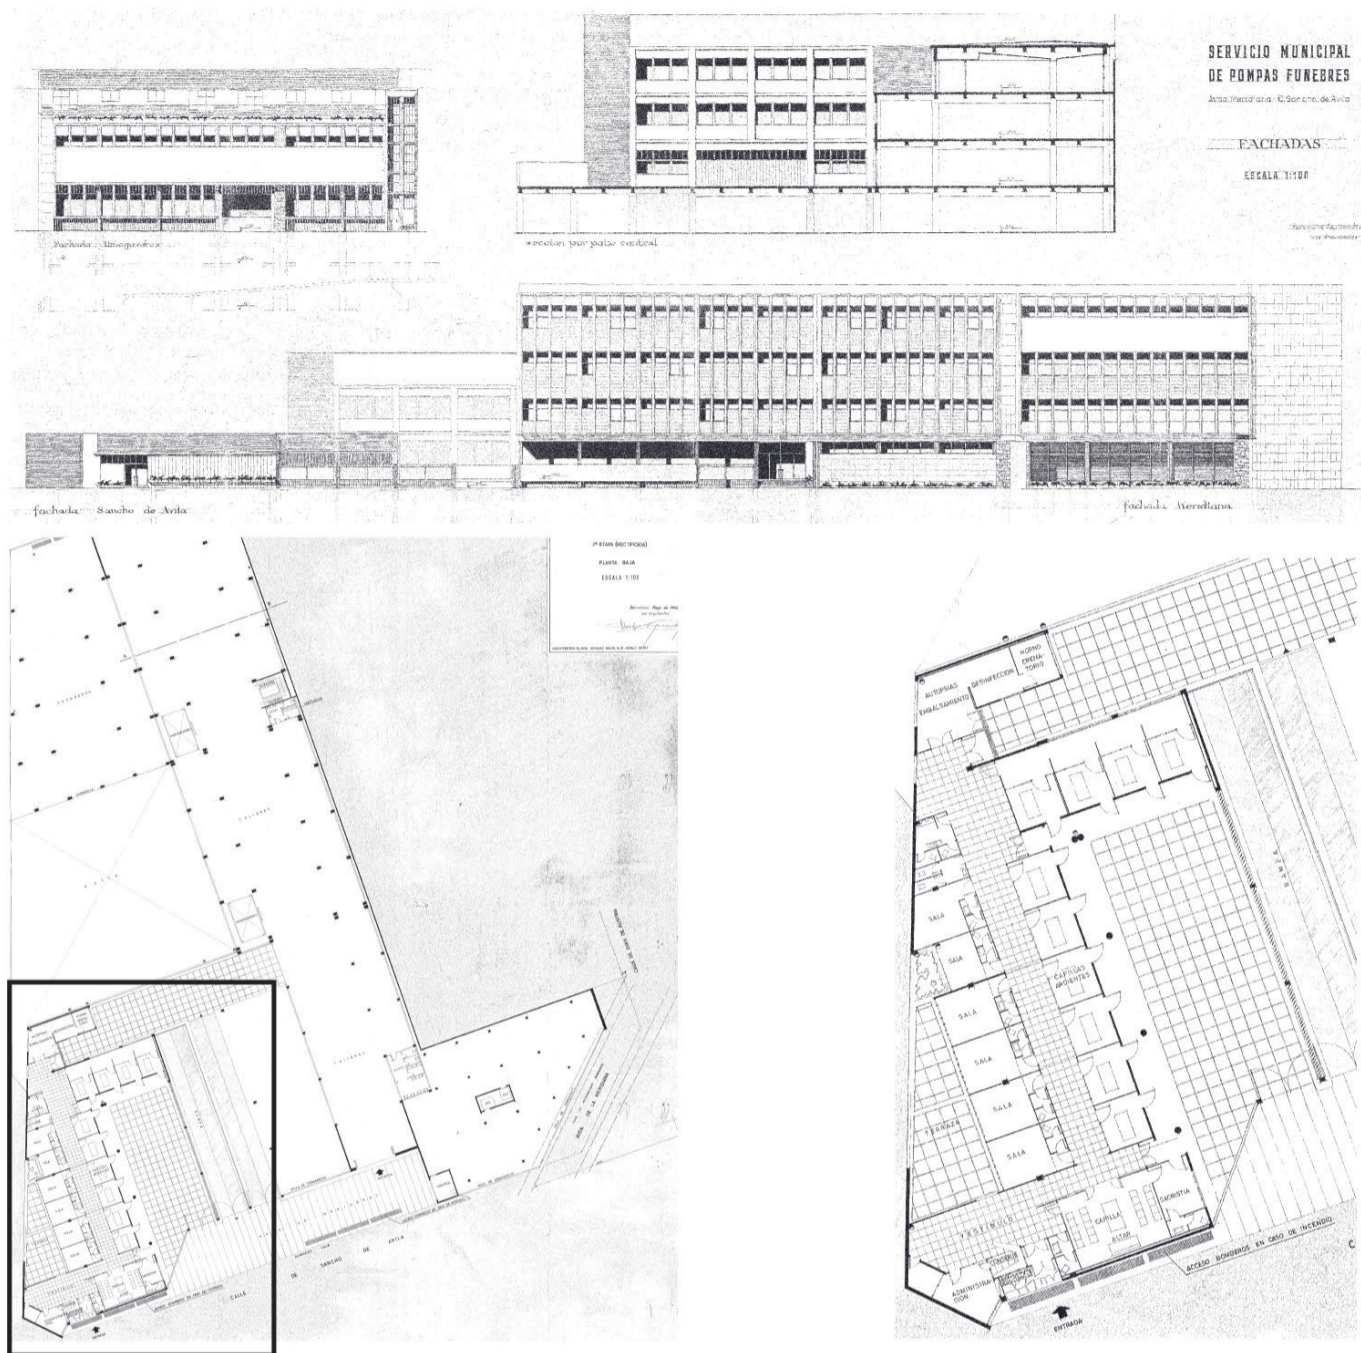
Josep Maria Soterias i Mauri y Enric Giral i Ortet, Anteproyecto de edificio para los servicios municipales de Pompas Fúnebres: plano de fachadas sobre calles Almogaváres, Sancho de Ávila y Meridiana. Abajo, plano de planta baja, y detalle ampliado del sector de acceso y capillas ardientes sobre calle Sancho de Ávila y, 1959. Documentación cedida por Fundación Mémora.
